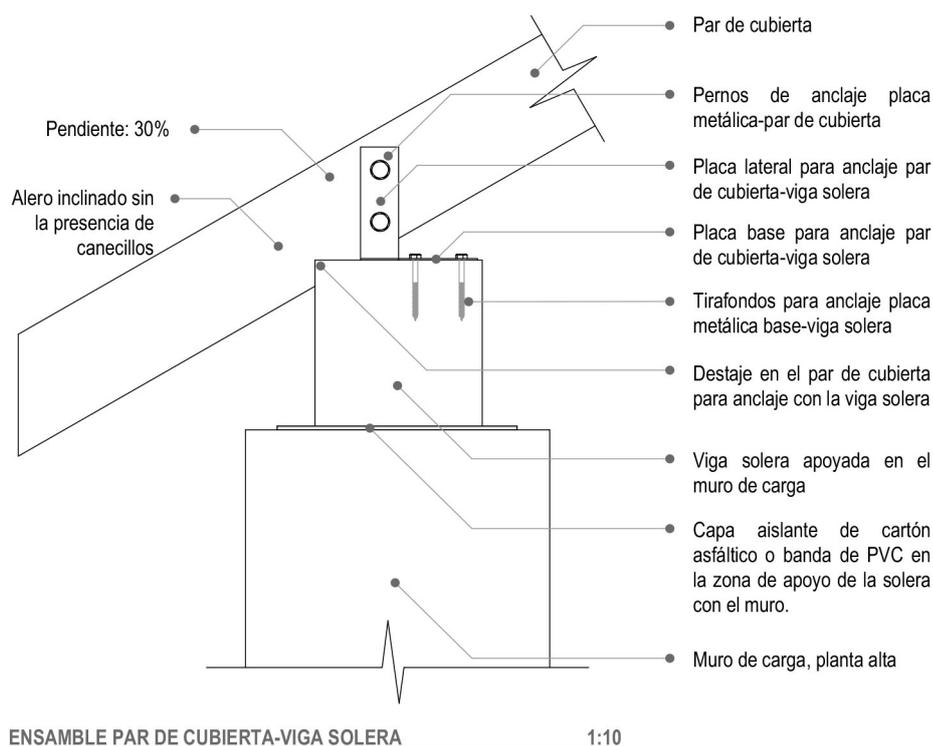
Detalle D12: Ensamble par de cubierta-viga solera
